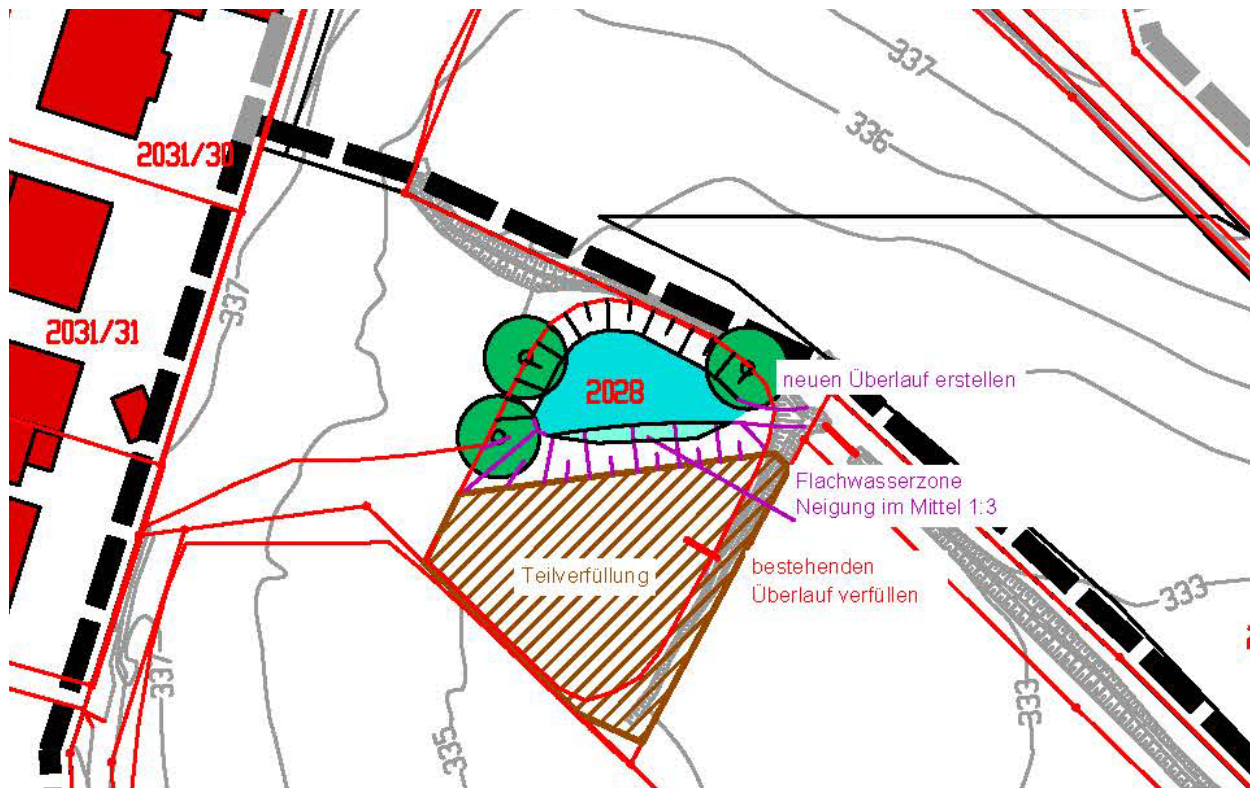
geplante Teilverfüllung des Regenrückhaltebeckens im Süden und Aufwertung des Nordteils
